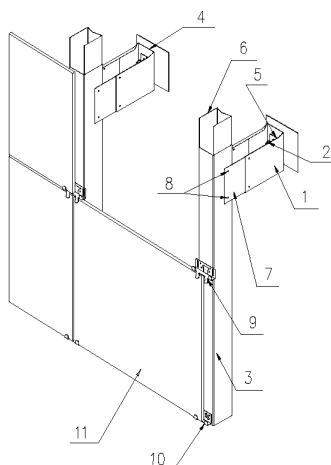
Типовая конструкция навесного вентилируемого фасада
